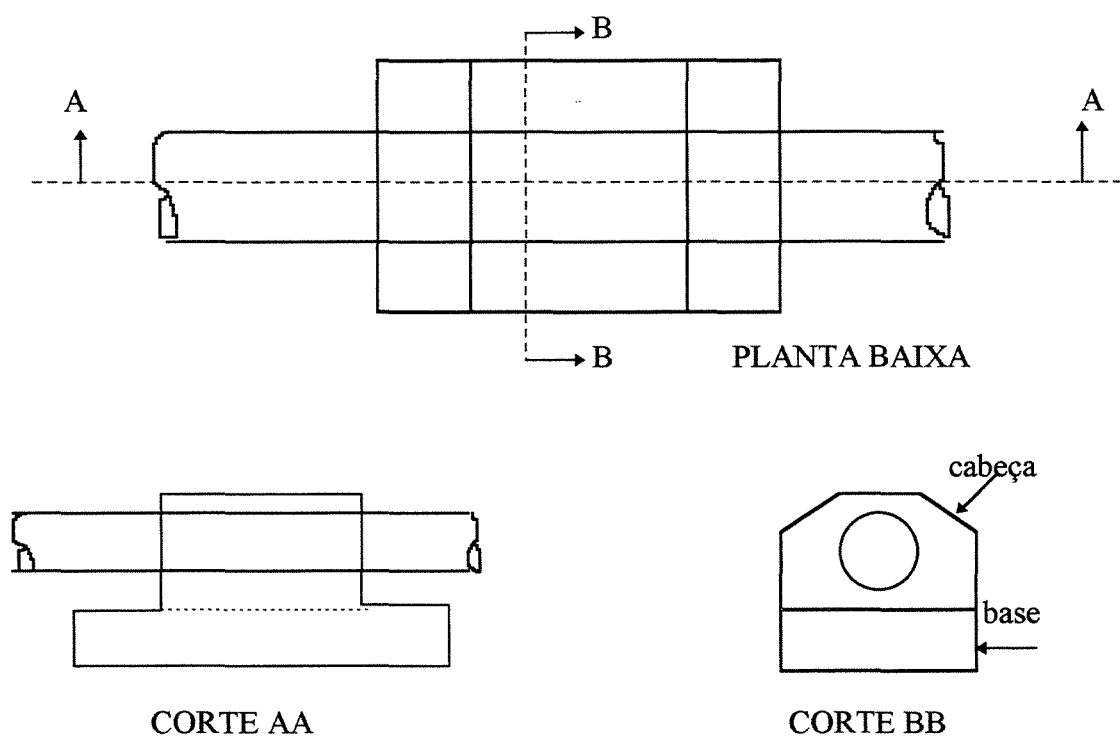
Geometria típica de um B.A. em um trecho reto de tubulação
